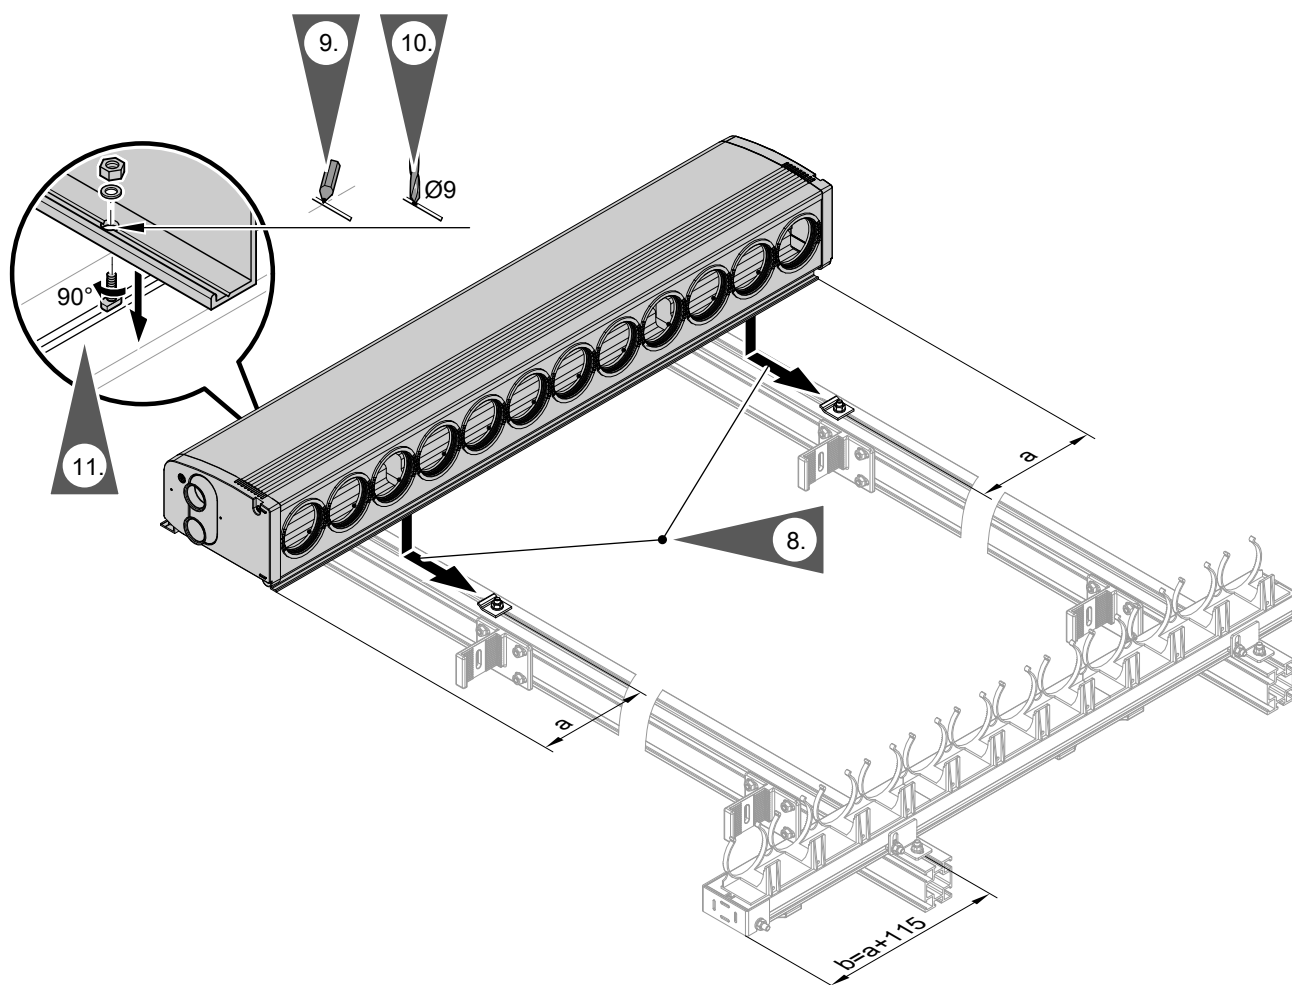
Размер a определяется после расположения соединительного корпуса по центру монтажных шин.
